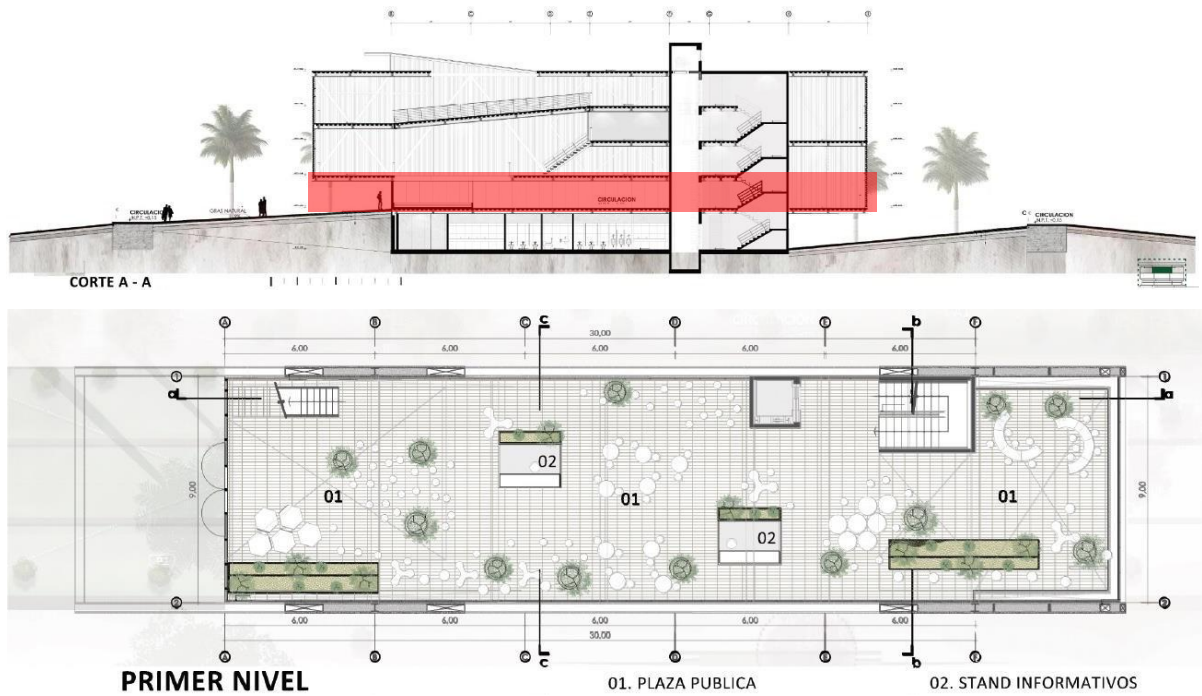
Plano de distribución del Recinto 03 (Primer Nivel).
